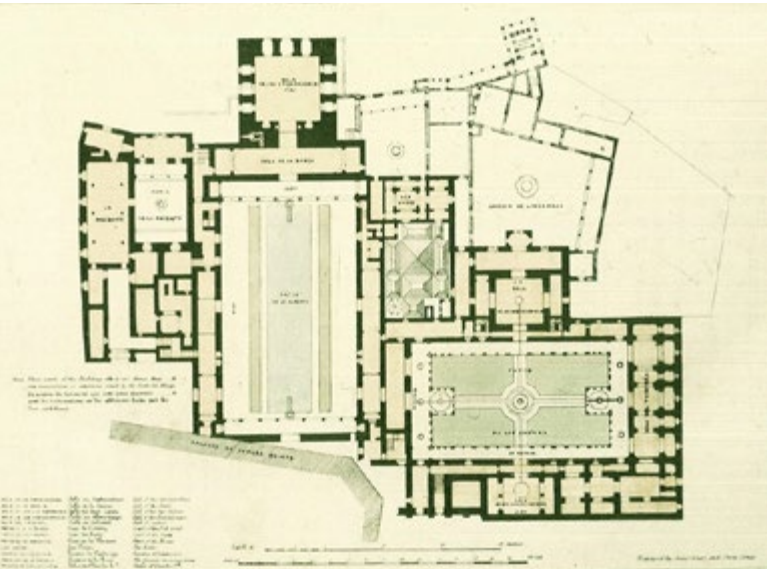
Planta general de los palacios nazaríes de la Alhambra (Archivo Junta de Andalucía)
